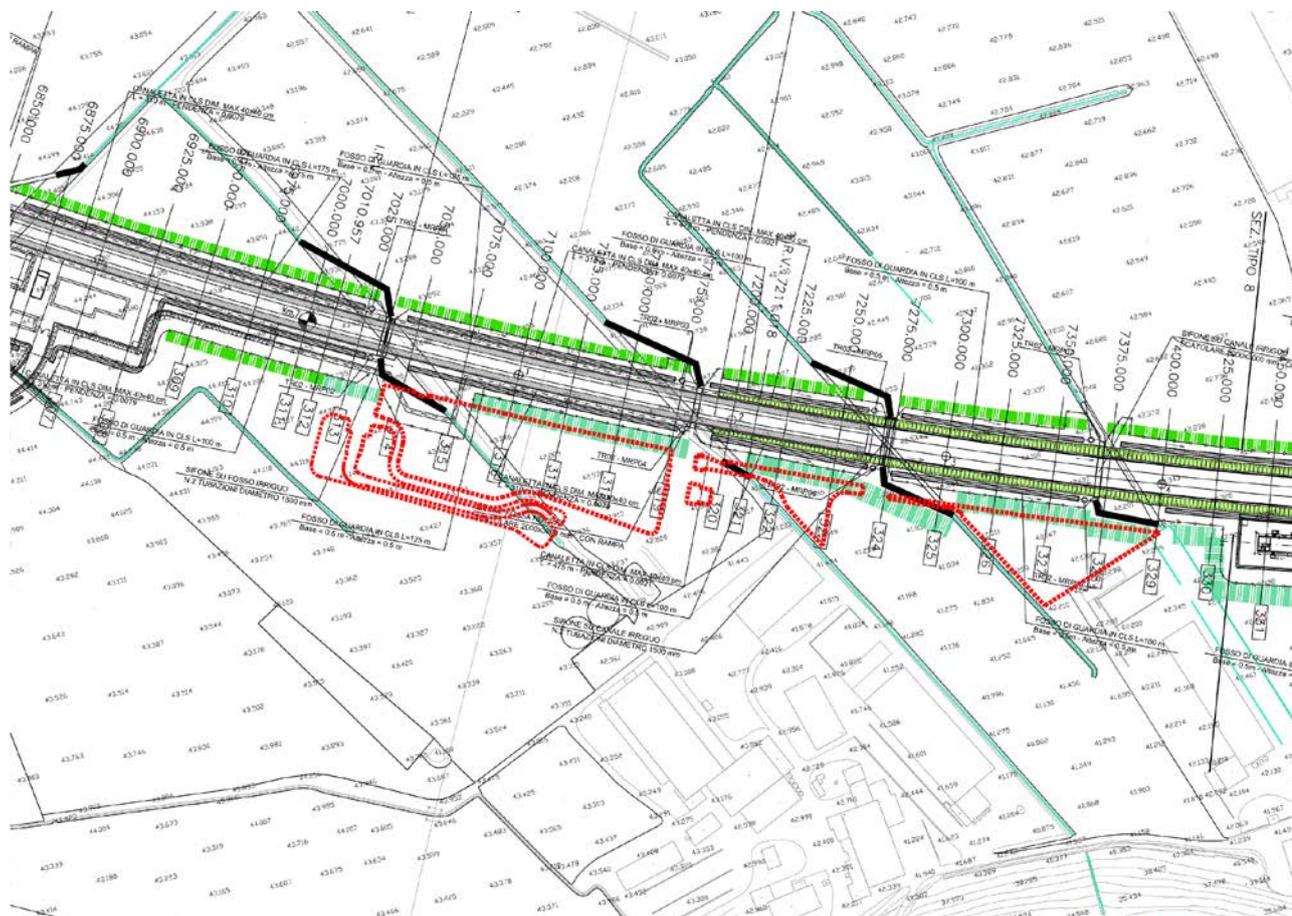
Stralcio Planimetria di PD – in rosso i perimetri delle nuove aree di intervento di PE
